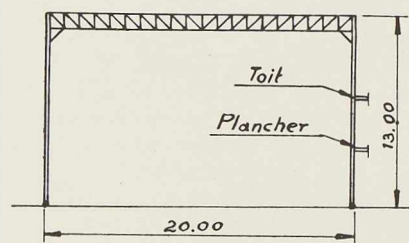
Portique transversal de la grande salle du Théâtre Municipal d'Utrecht. La béquille de droite supporte aussi le plancher et la toiture du foyer.
